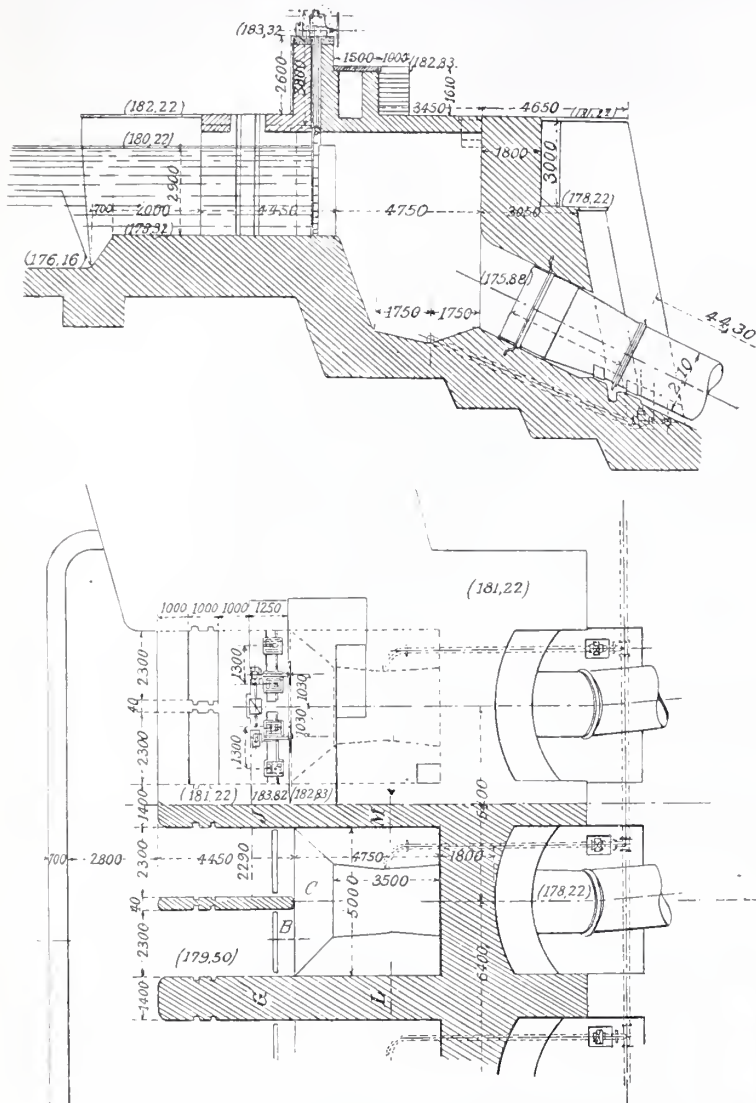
u. 8. Querschnitt und Grundriss des Wasserreservoirs J mit Rohrleitung. 1:250.
